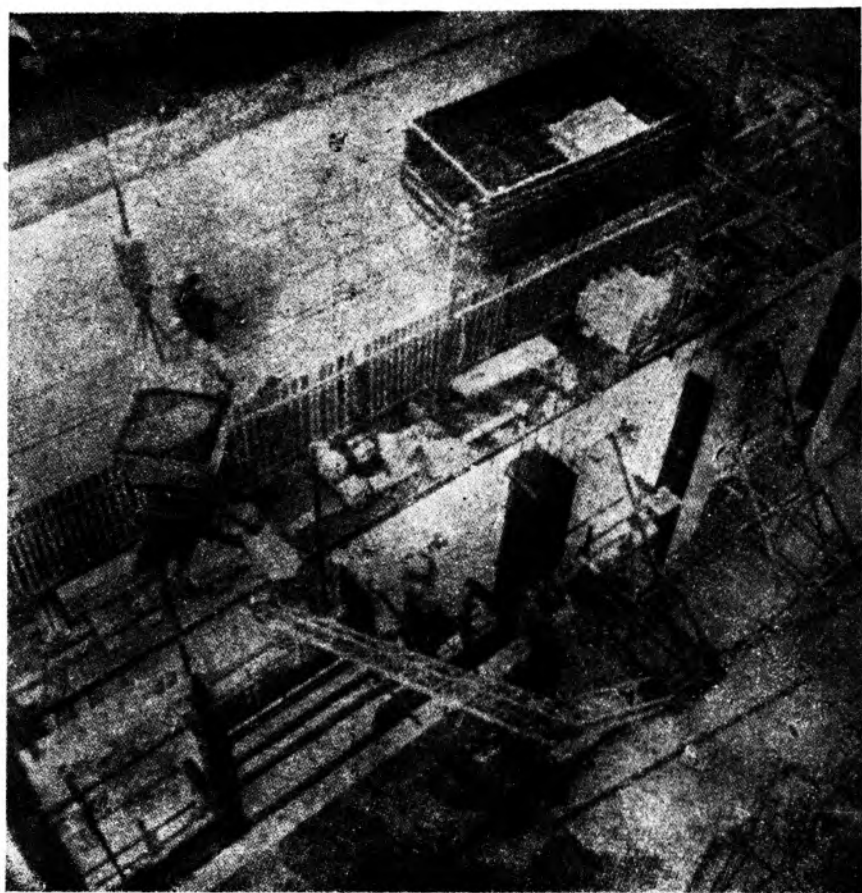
Betonowanie ściany zewnętrznej. Z lewej strony widoczny kubek z betonem, który właśnie opuszczony jest na miejsce betonowania przez kran Wolfa. Na pierwszym planie widoczny jest ustawiony na rusztowaniu ręczny dźwig montażowy; konstrukcja dźwigu wykonana z lekkiego metalu. Na zdjęciu widoczne są poza tym szalowania stalowe do żelbetowych słupów szkieletu. Z prawej strony, w górnym rogu zdjęcia widać wieżę kranu Wolfa.
